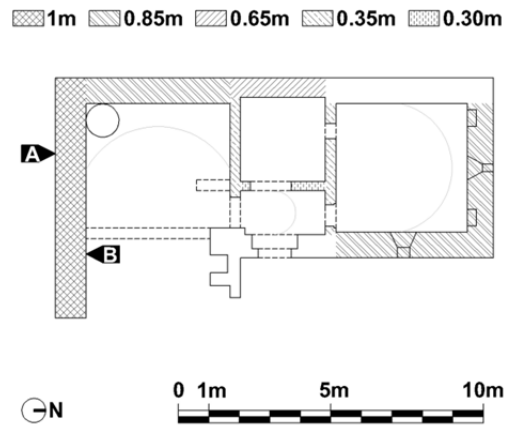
Planta baja del castillo Gilbertfield con indicación de los distintos espesores de muro. A y B definen la posición de las imágenes de 1m² obtenidas a nivel de planta baja.
